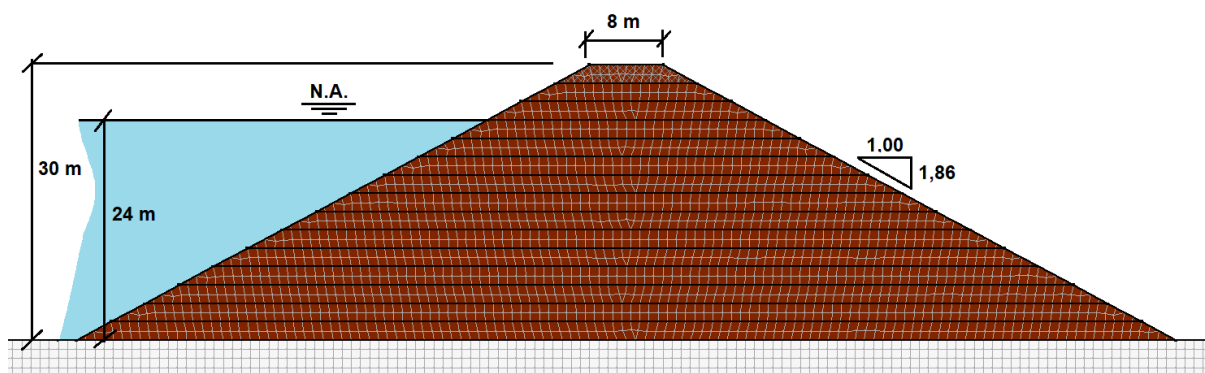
Geometria da seção da barragem com a malha discretizada e as etapas de construção
